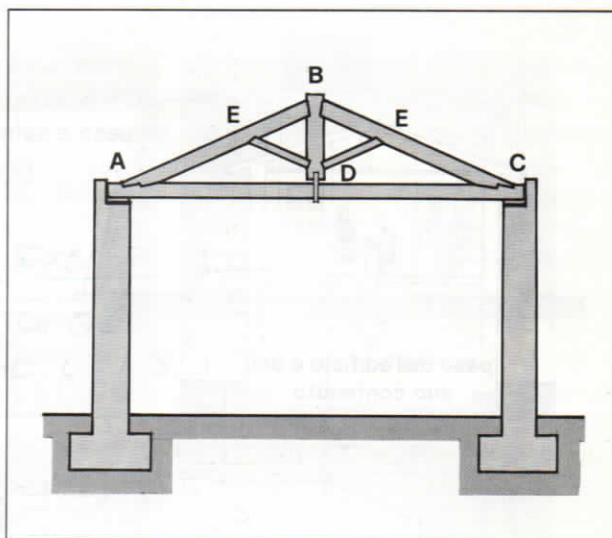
Esempio di sistema strutturale semplice: trave composta (capriata) su pareti in muratura.
